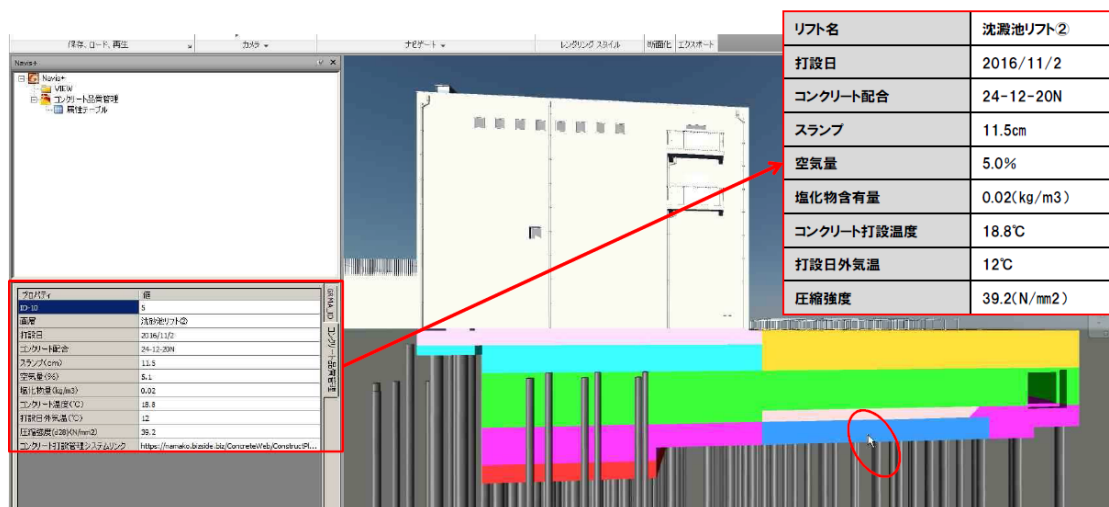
下水道 BIM/CIM モデルへの施工情報の付与の例
